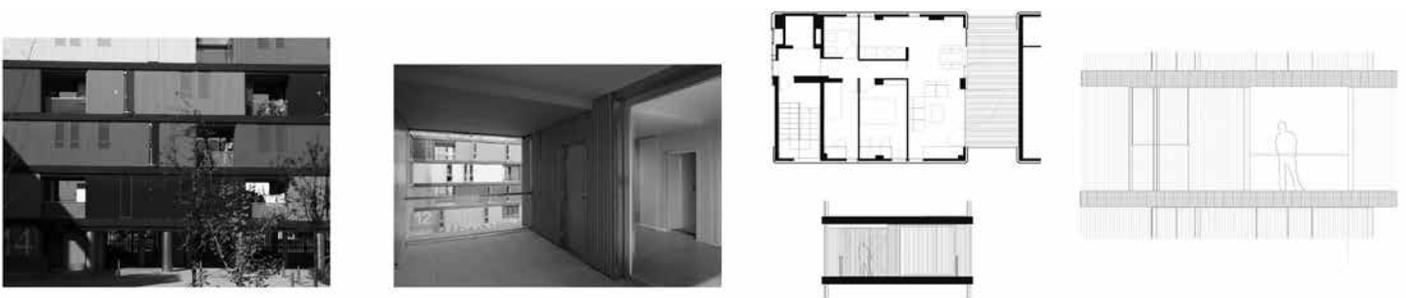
CARABANCHEL, alzado exterior, vista espacio intermedio, planta y sección
